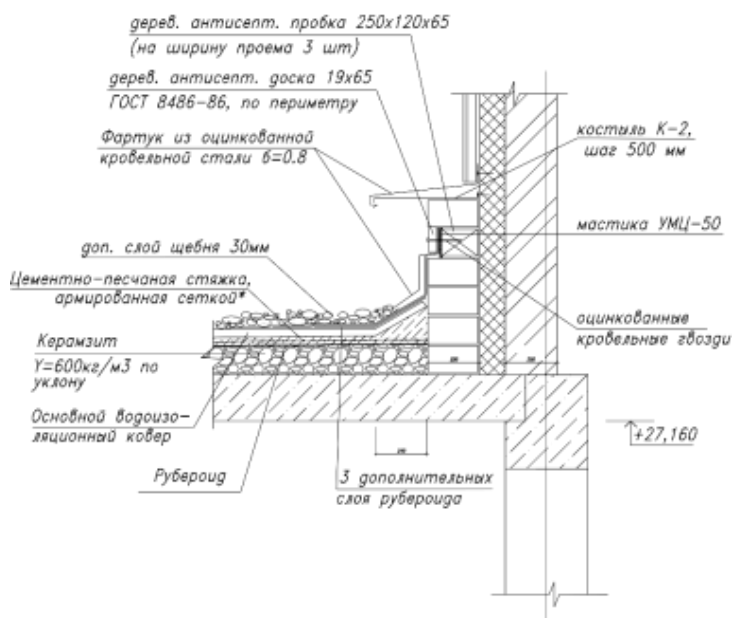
Узел (Деталь примыкания кровли к стене (иллюстрация автора))
